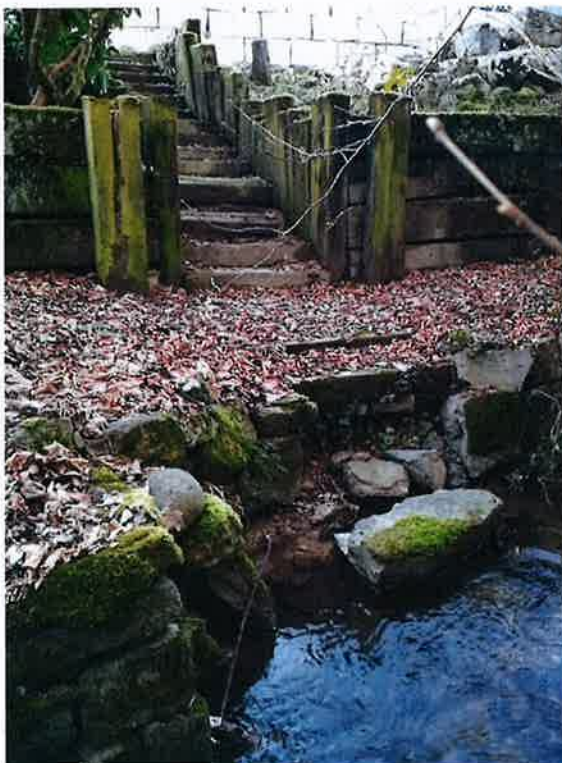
Mur de planches en bois situé en rive gauche, sur la parcelle n° 412
